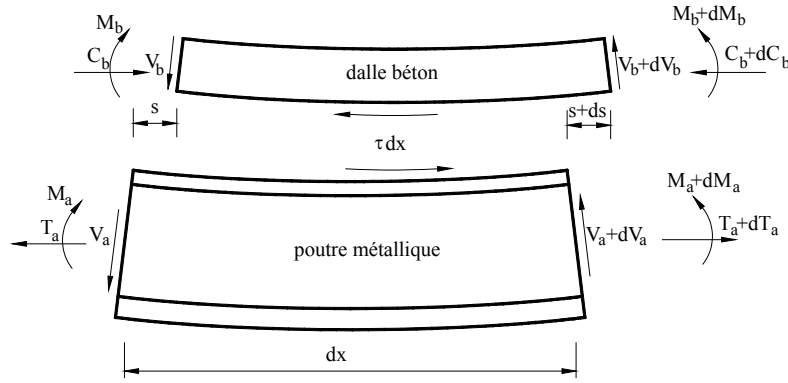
Efforts internes sur un élément de longueur finie de la poutre mixte [46]
